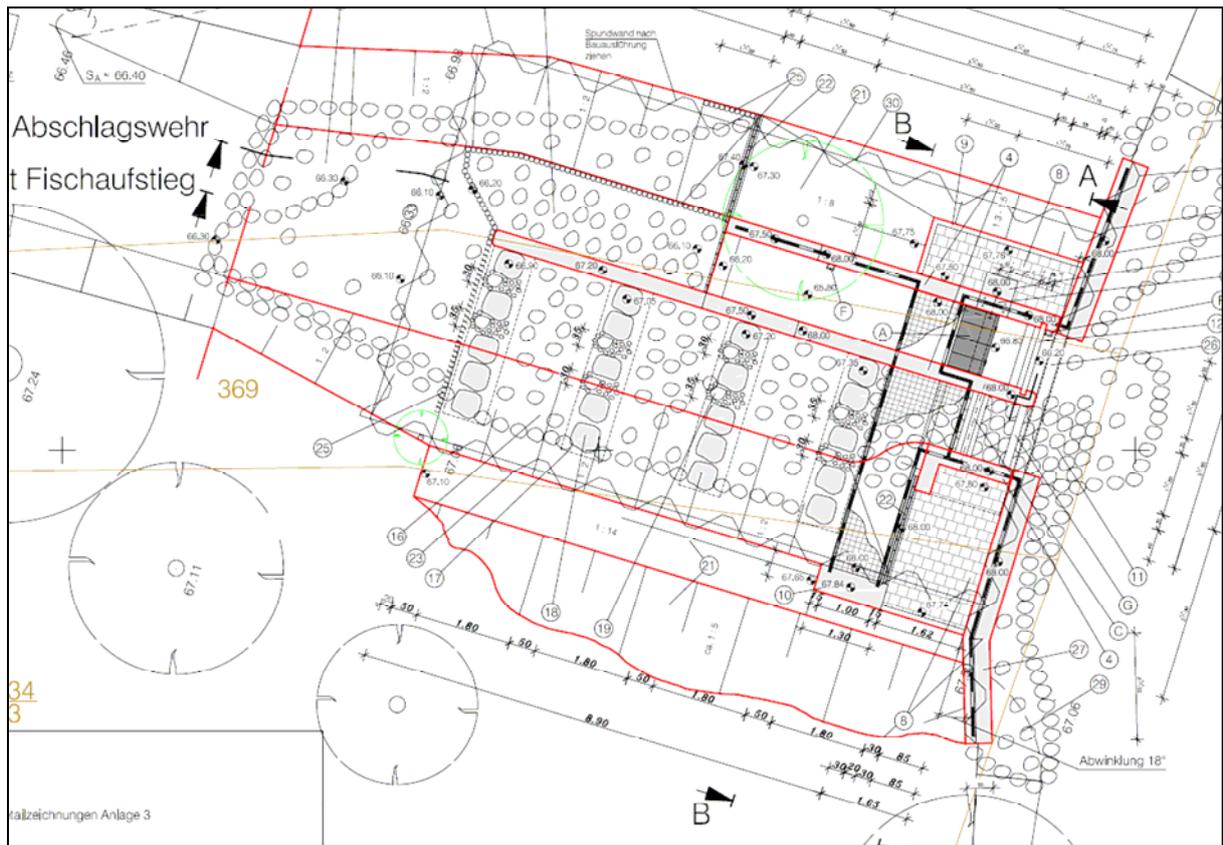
Grundriss des Abschlagbauwerks Freigraben Meinsdorf
